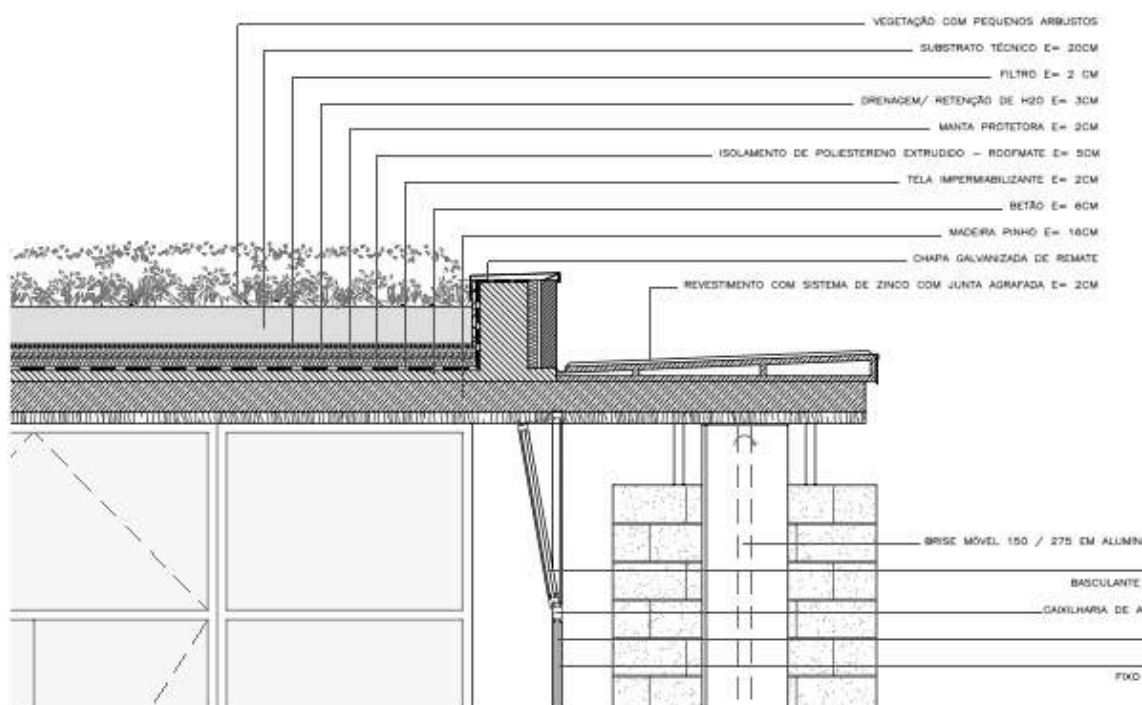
Pormenor da cobertura ajardinada no projeto de dissertação.
